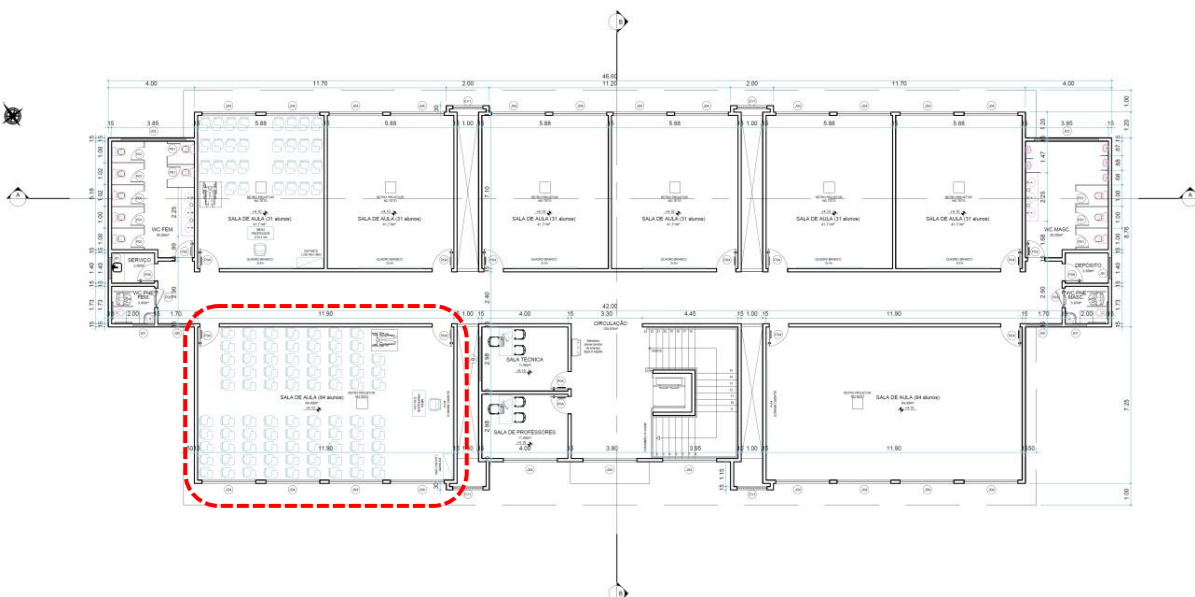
Planta Baixa: pavimento superior – Bloco de salas de aula de dois pavimentos, com destaque para a sala adotada como modelo. Fonte: Acervo SIN/UFERSA
